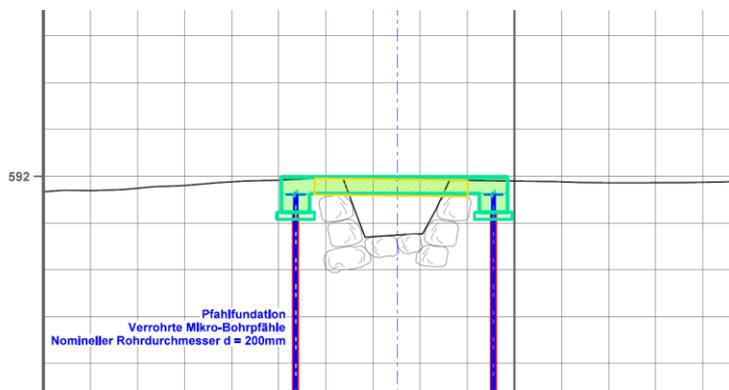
Längsschnitt durch Brückendurchlass (Ausschnitt aus Plan-Nr. 1278-002)
